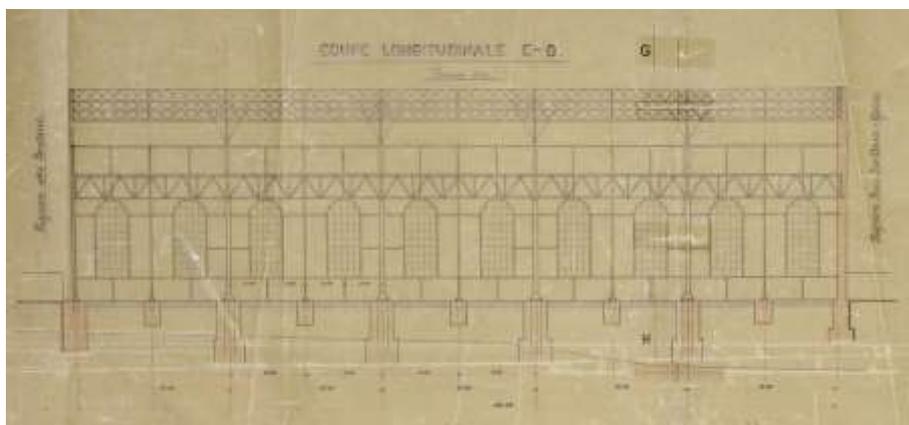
Coupe longitudinale façade est (détail) (AVV, 96.01, Fonds ACMV, Plans de la nouvelle halle de montage des turbines n°118/D115-124).
